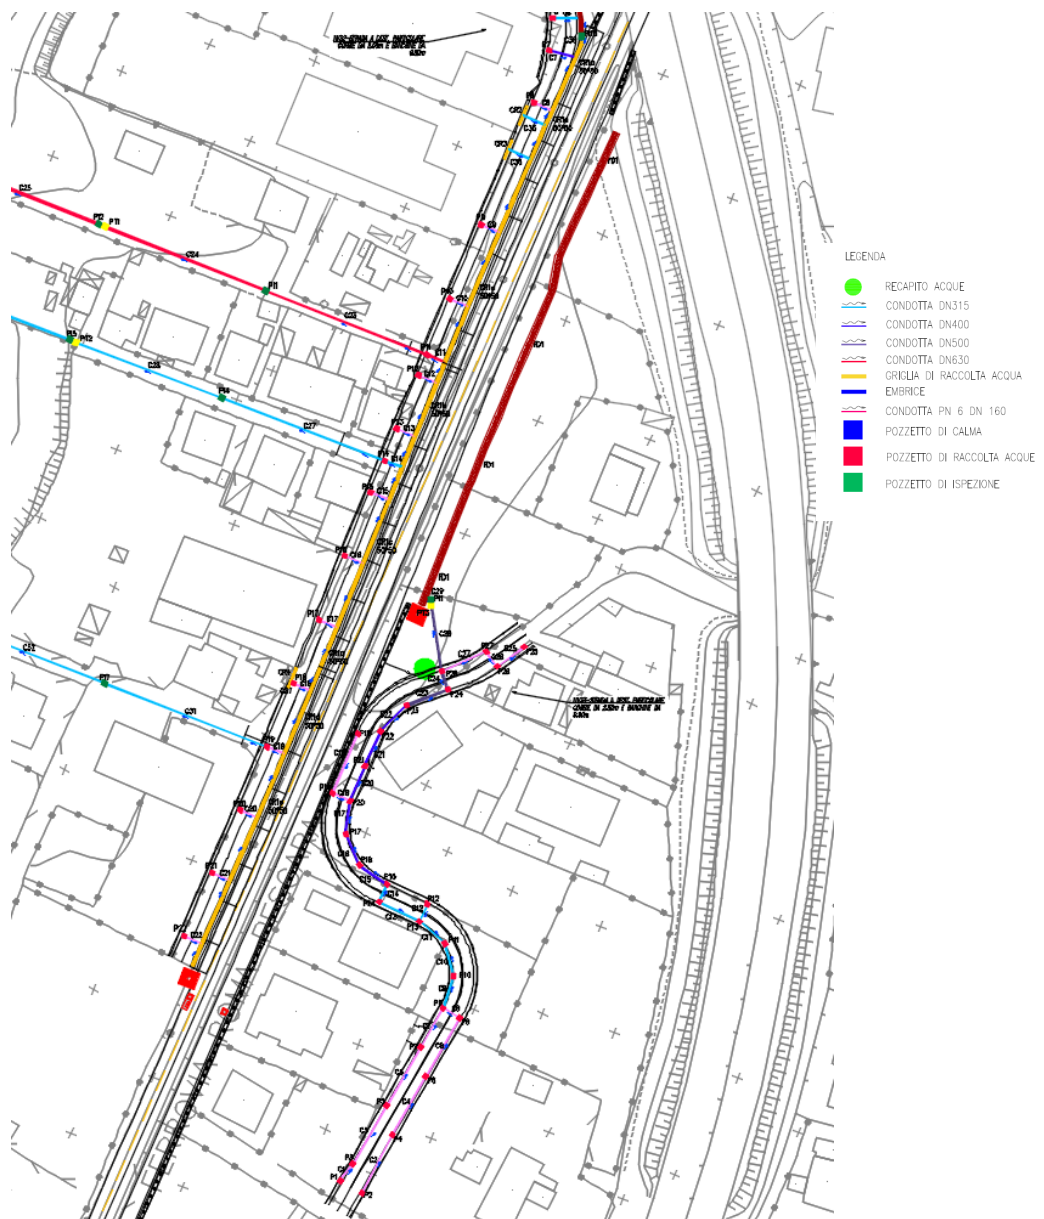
Stralcio planimetrico della rete di drenaggio Nuova Viabilità NV33
